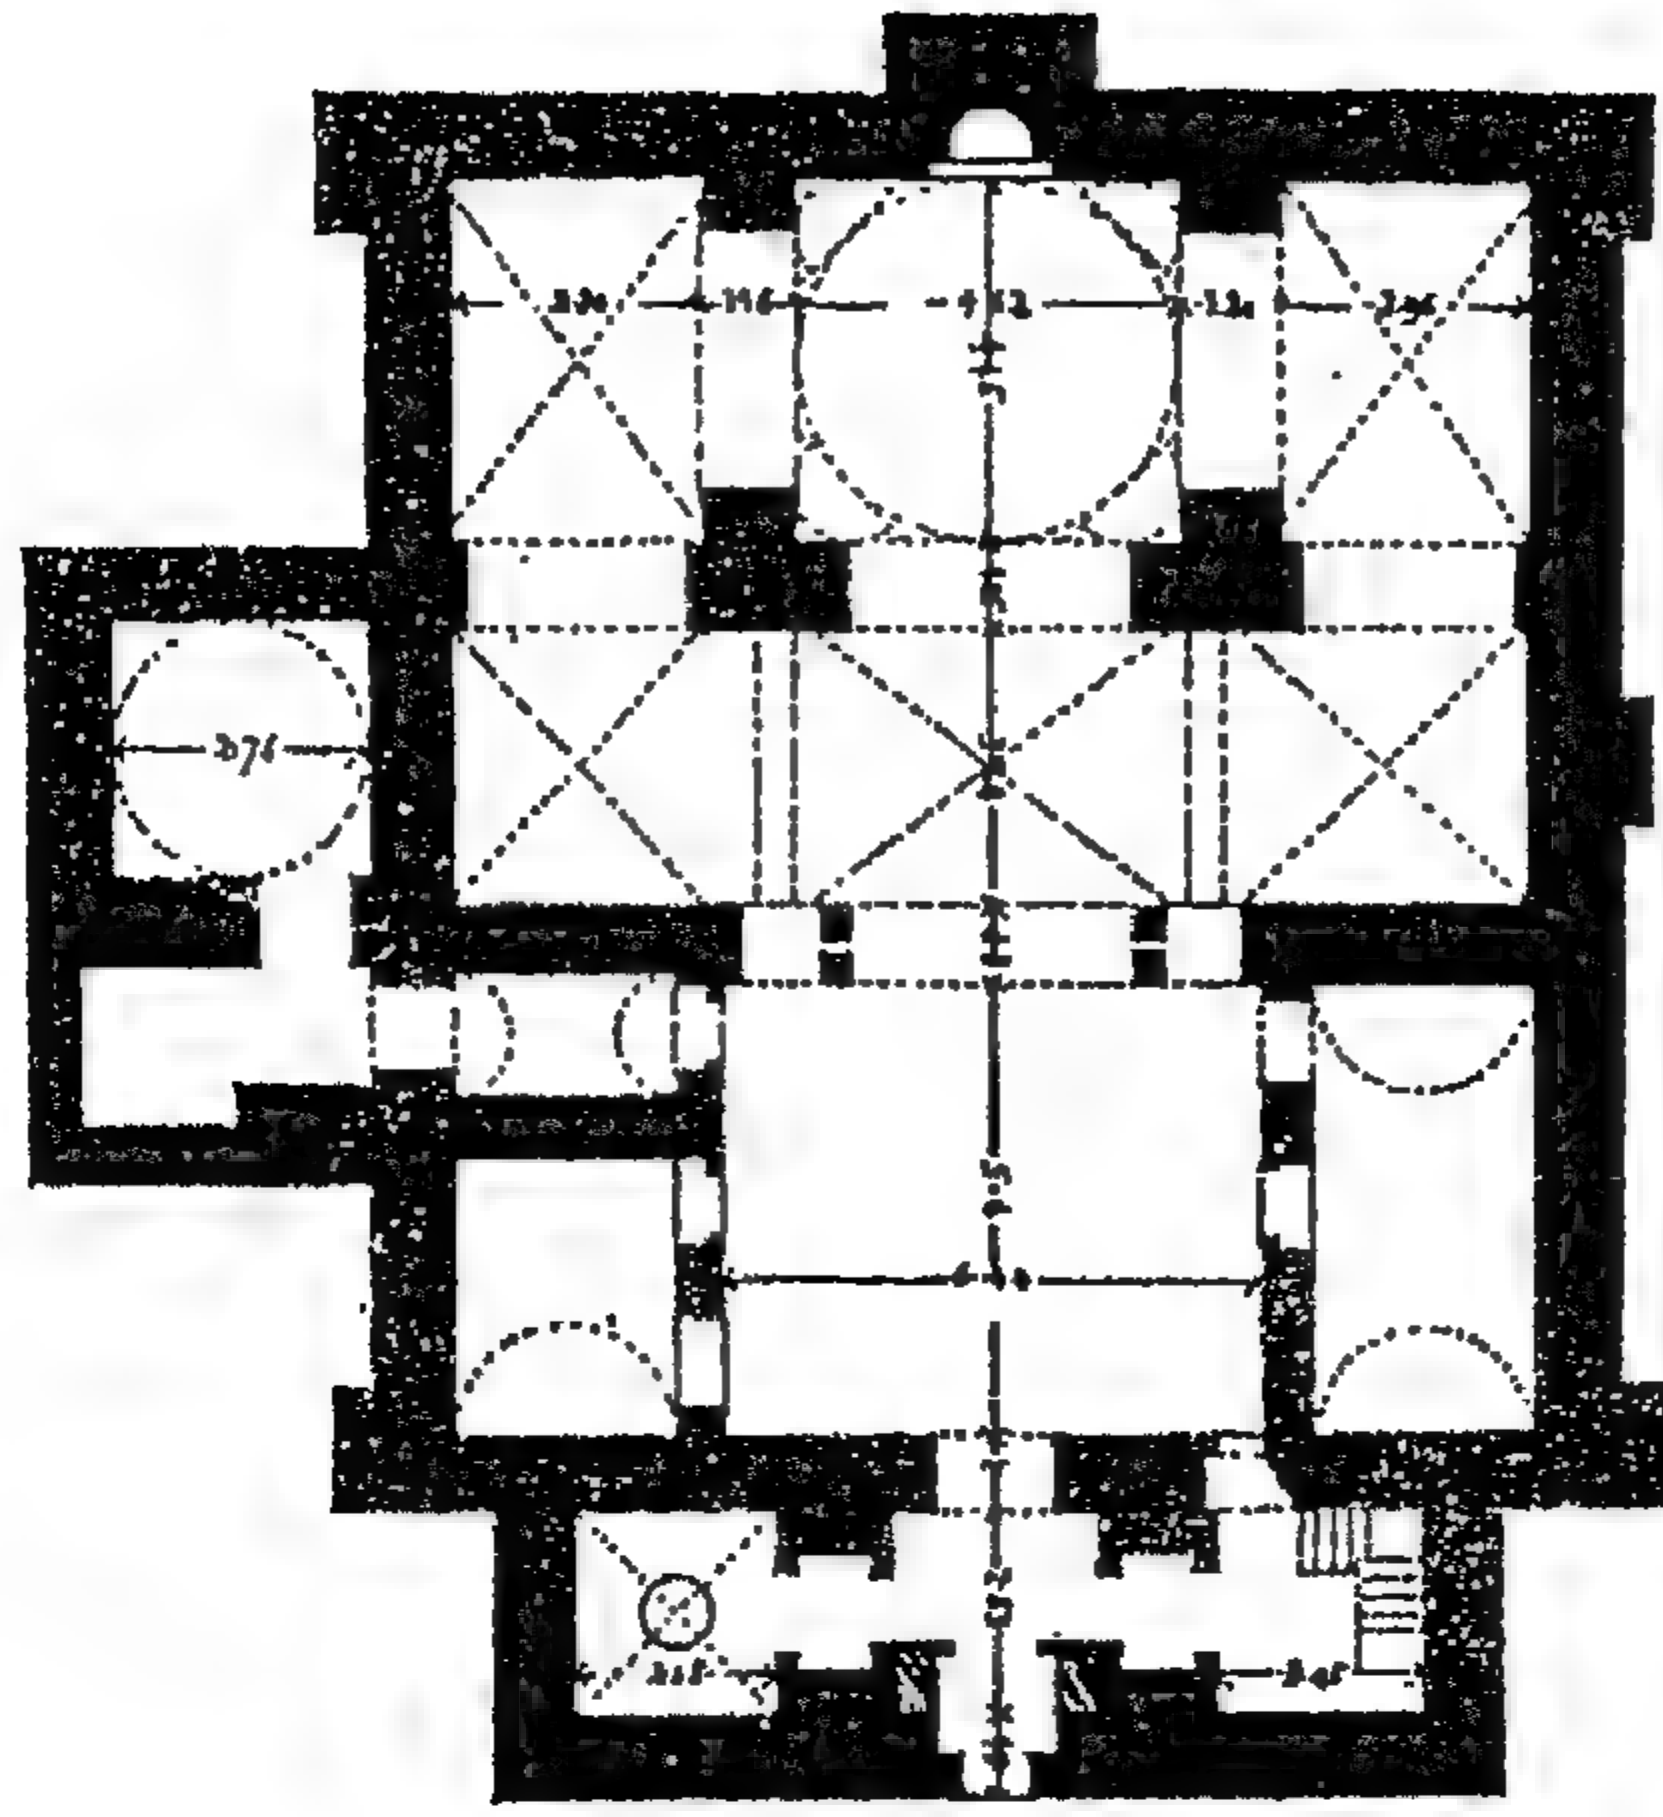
مسقط أفقي لجامع محمد علي بالقاهرة . (عن : هوتكروفييت) .
